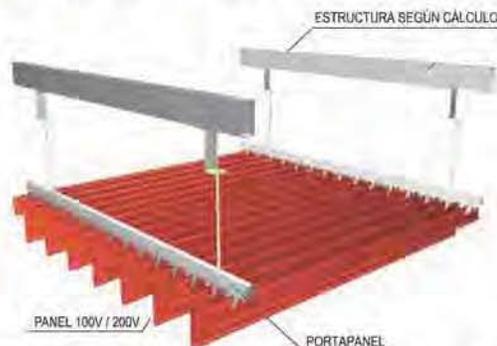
Detalle de montaje sobre los portapaneles anclados a la estructura.
